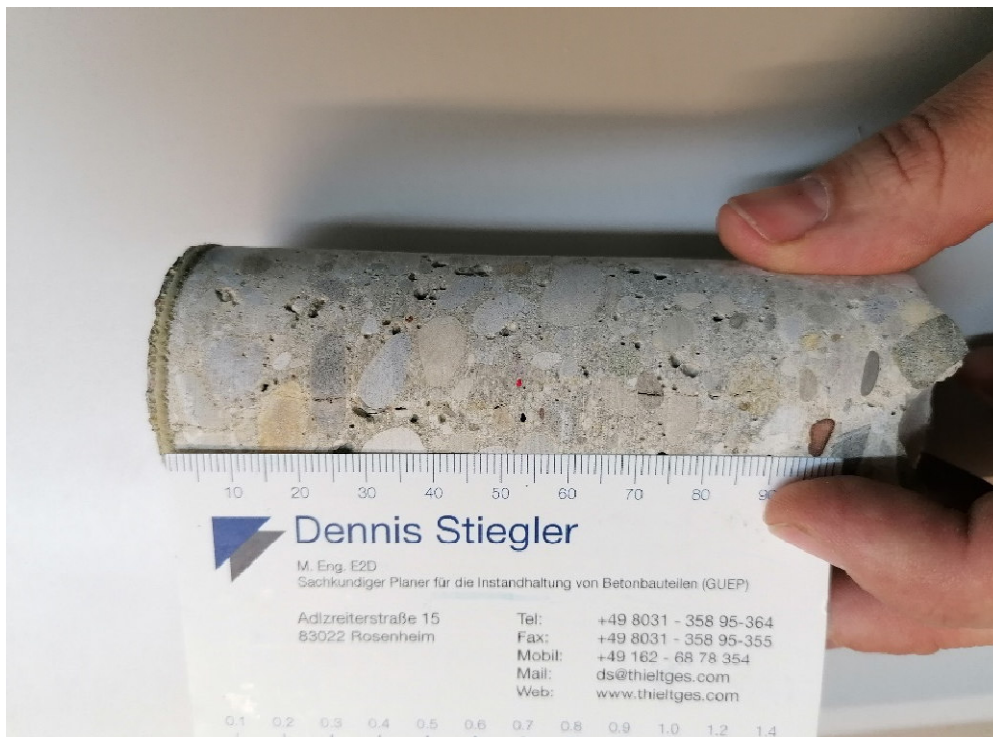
Bohrkern BK 02 im Querschnitt, mit erkennbarem Riss im Betonuntergrund
